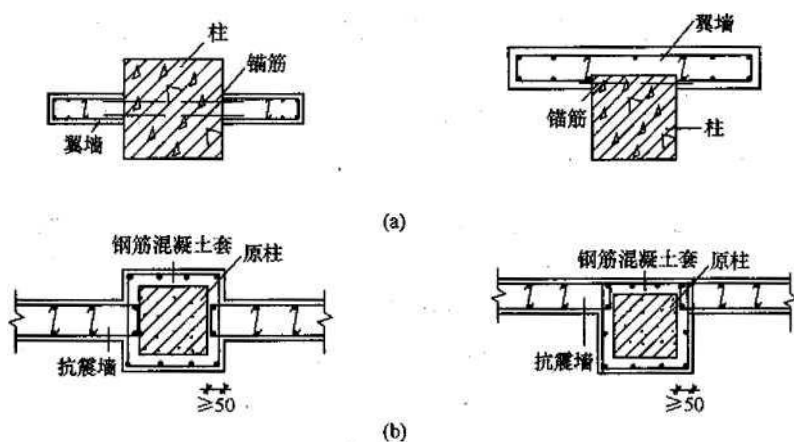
增设墙与原框架柱的连接 (a) 锚筋连接；(b) 钢筋混凝土套连接
